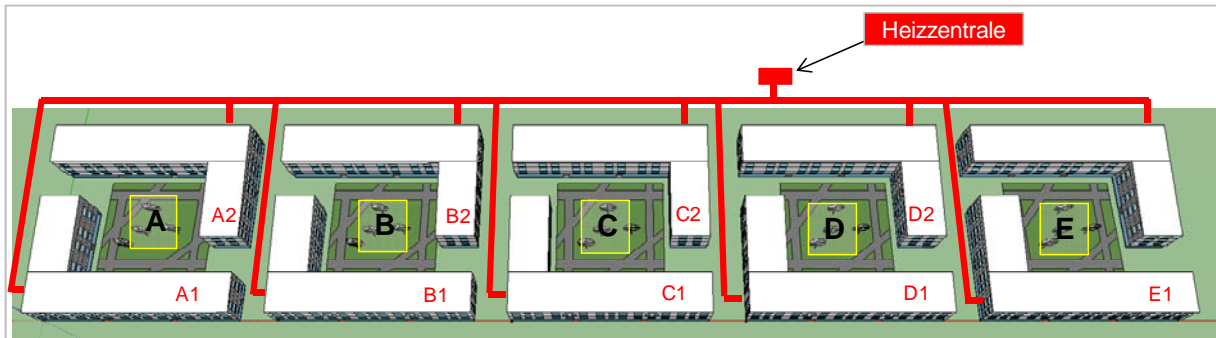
Lageplan Quartier Neubau mit Nahwärmenetz und Lage der Heizzentrale
